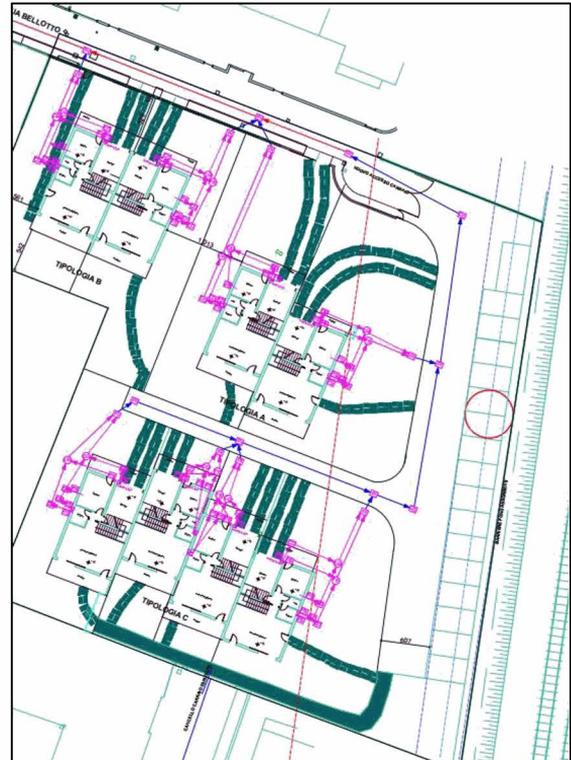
Planimetria della rete fognaria di progetto dell'area
